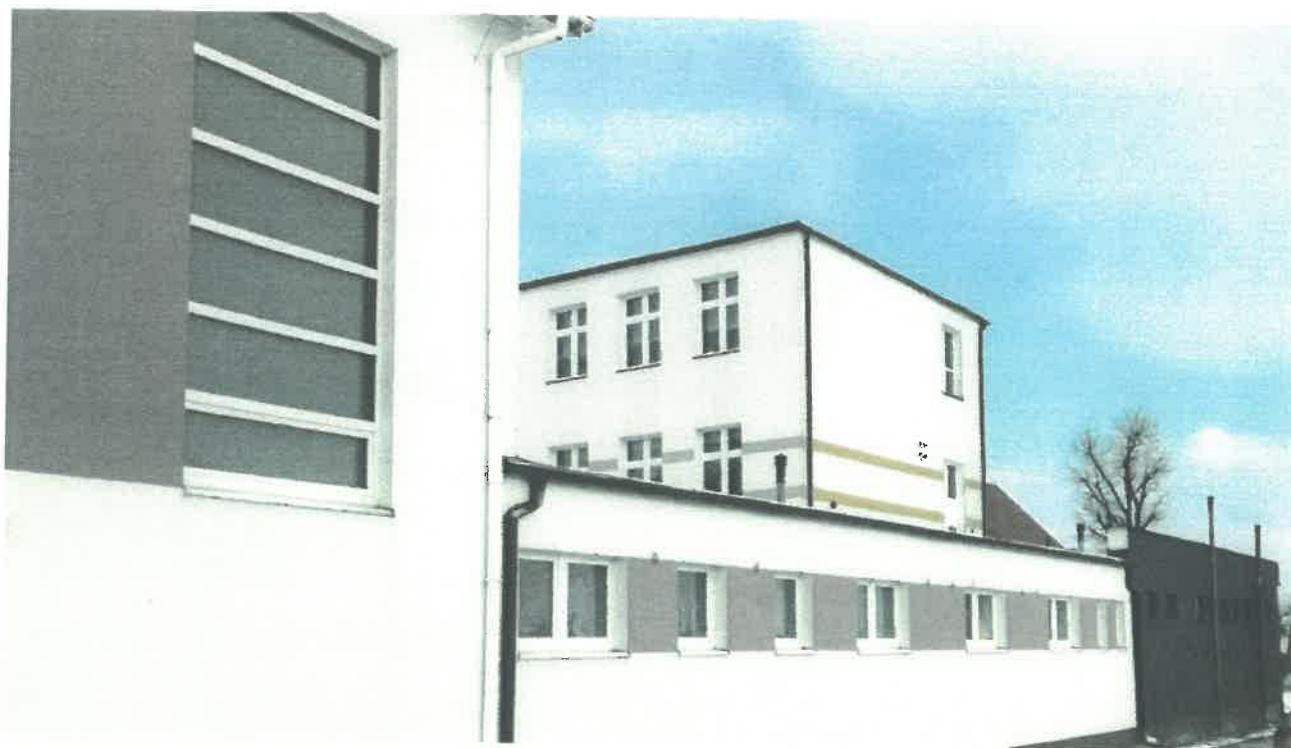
Fragment elewacji północnej budynku Szkoły Podstawowej
